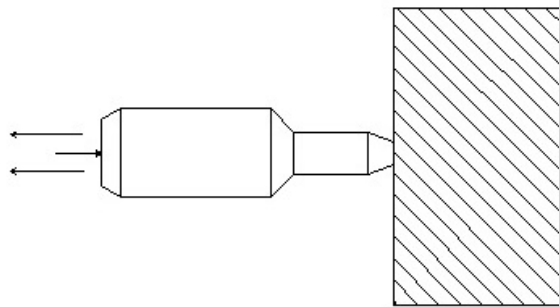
Схема випробувань бетону методом відскоку
